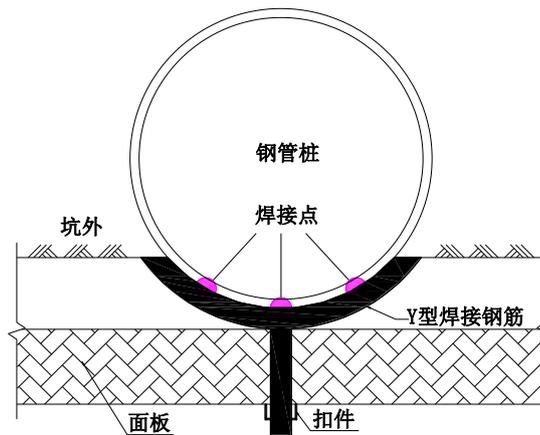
Y 型钢筋连接装配式面板剖面图
